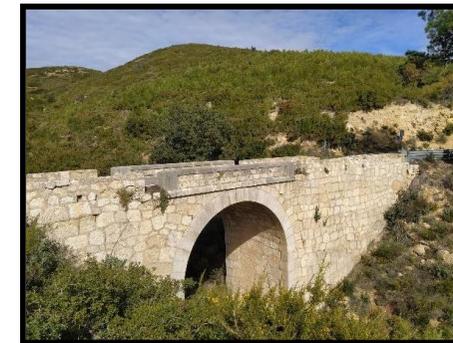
Puente sobre barranco de la cierva. Fuente: Elaboración propia.
